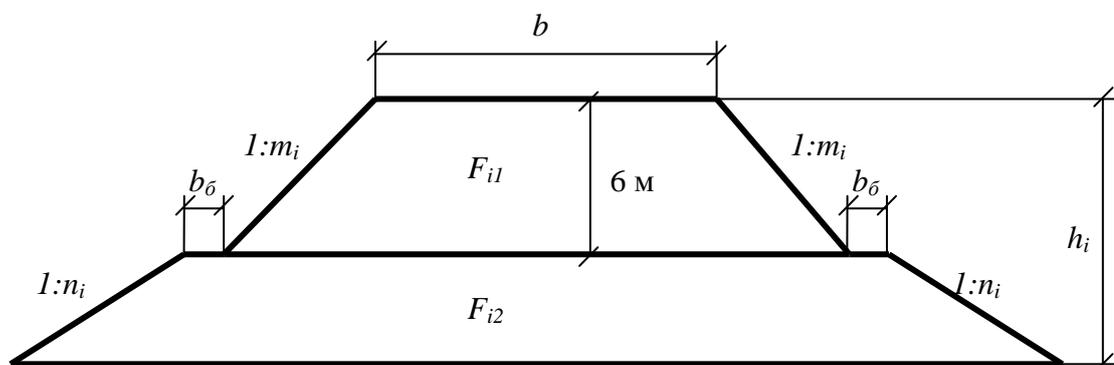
Элементы поперечного сечения насыпи высотой более 6 м
